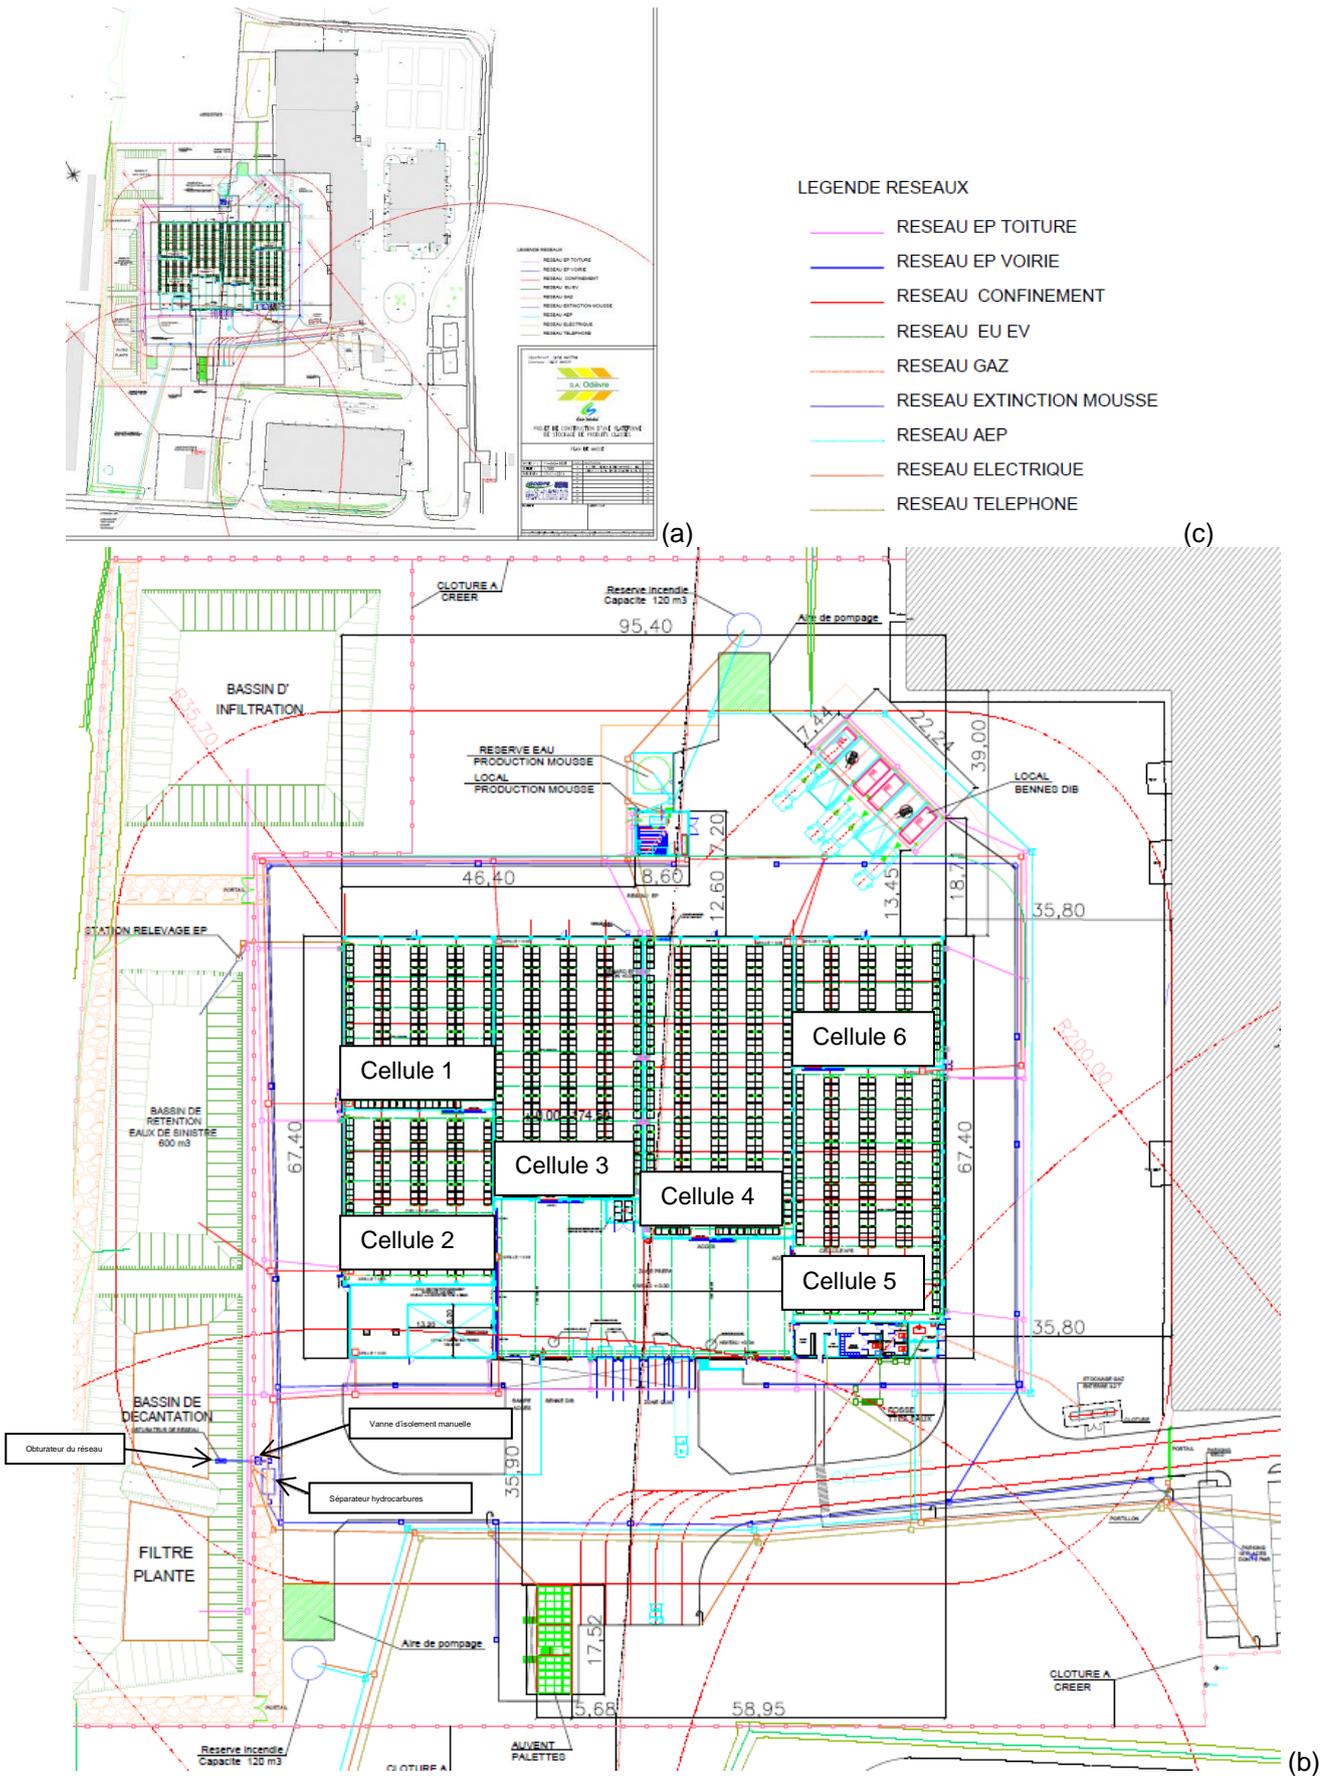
Plan du projet de plateforme : (a) plan d'origine extrait du rapport DDAE [6], (b) zoom, (c) légende
